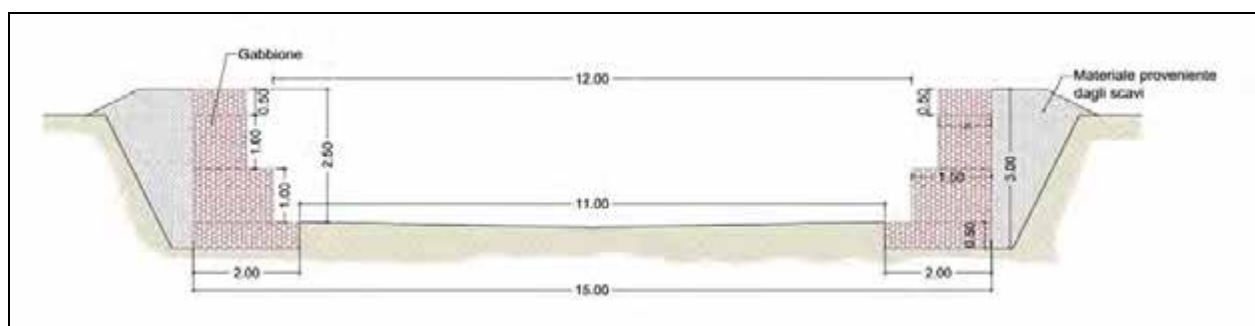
Sezione tipo (da sez. 5.29 a sez. 5.02)
